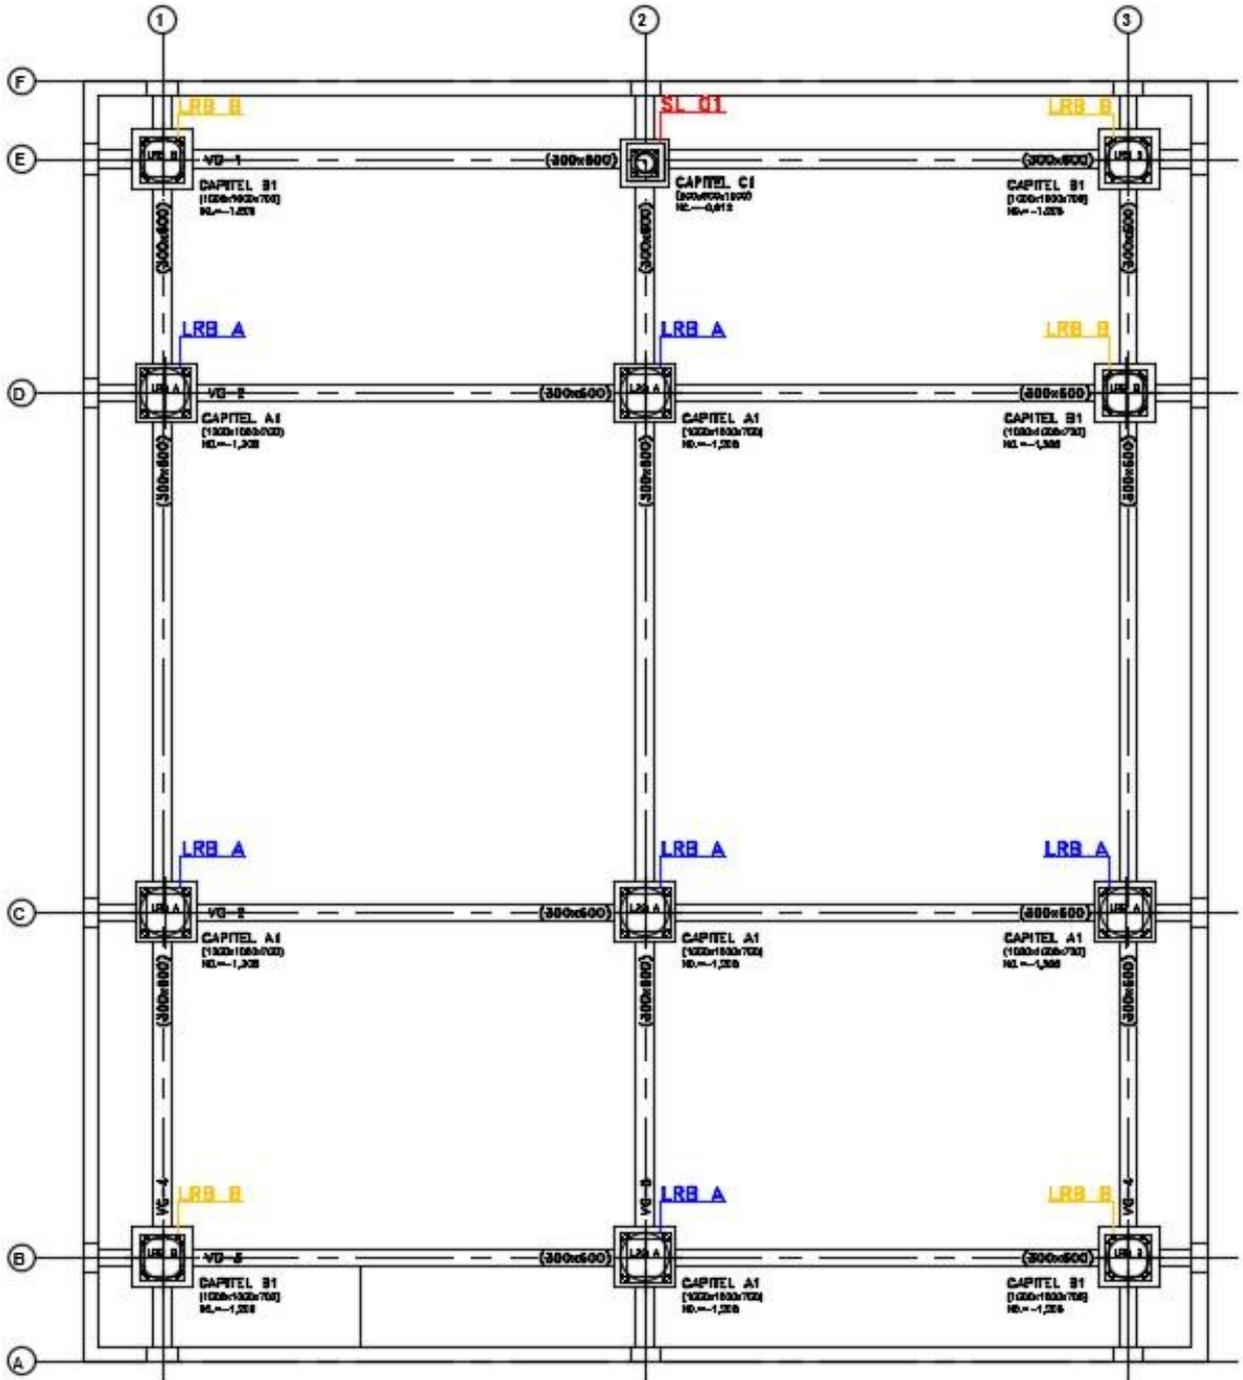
Nivel Técnico – Planta (NC. =-1,206) y Detalles
